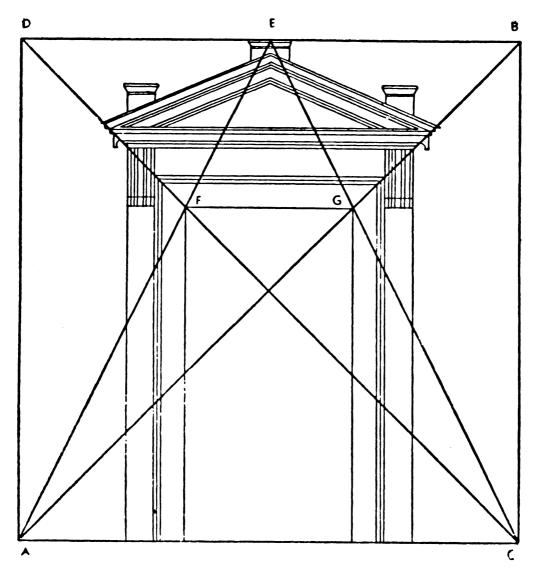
PRIMER LIBRO DE SERLIO. CONSTRUCCION DE UNA PUERTA.
